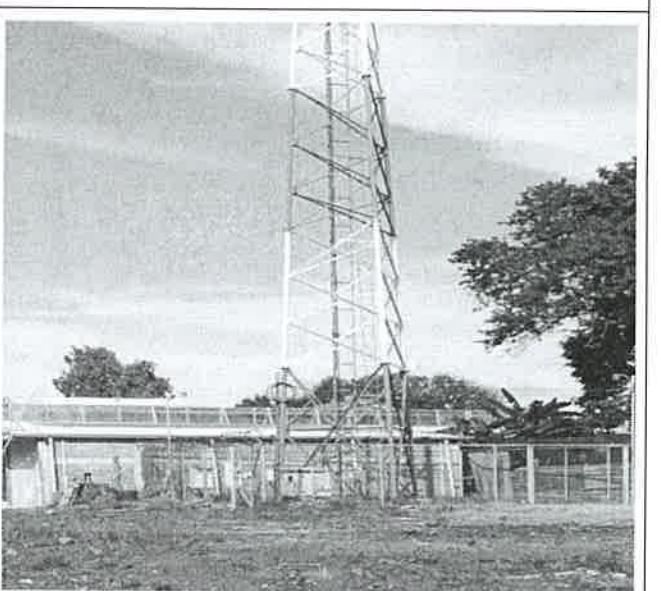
Vista del lote y la sección cercada donde se ubica la Torre..
